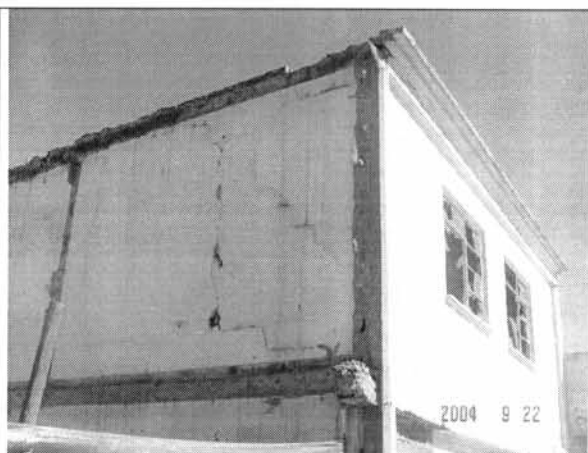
Deterioro leve en elementos no estructurales de fachada.
